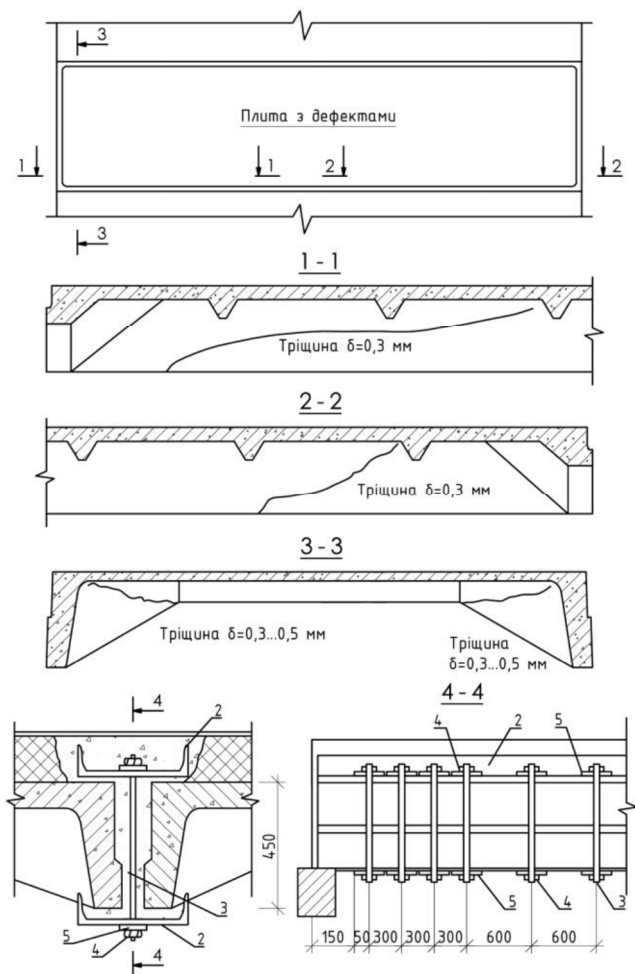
Дефекти та посилення конструкцій залізобетонних плит покриття на МЗБВ.
